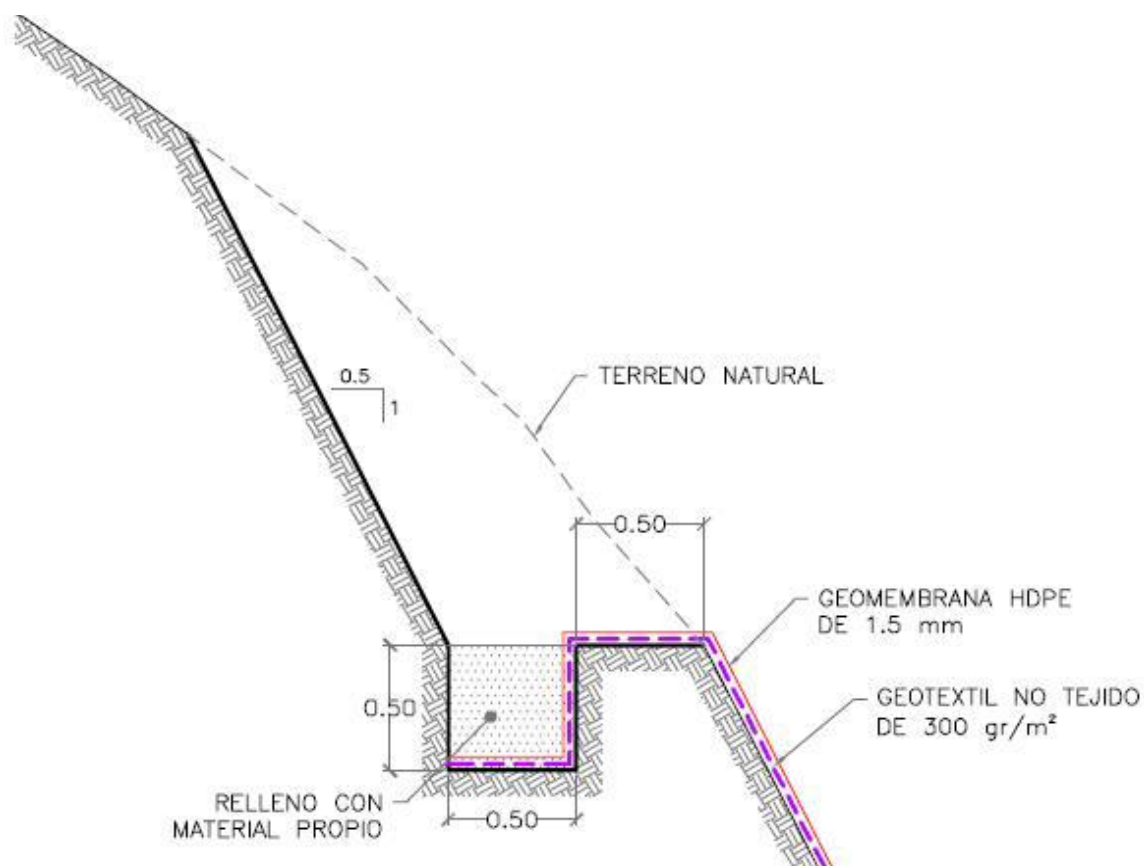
Detalle de anclaje de Geomembrana en margen izquierda
